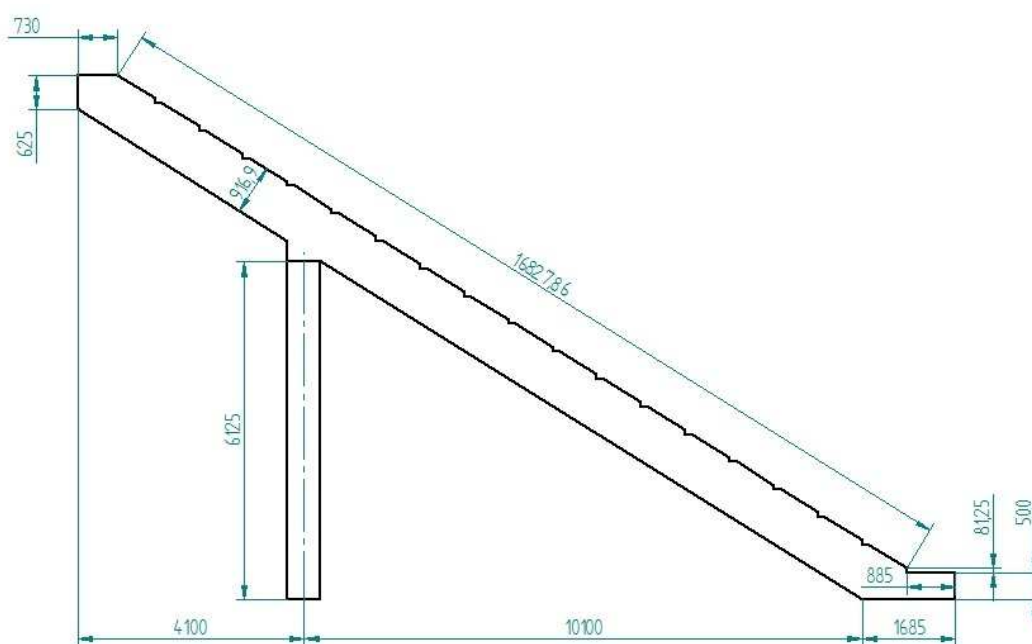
Pórtico porta-gradas predimensionado (dimensiones en mm)
